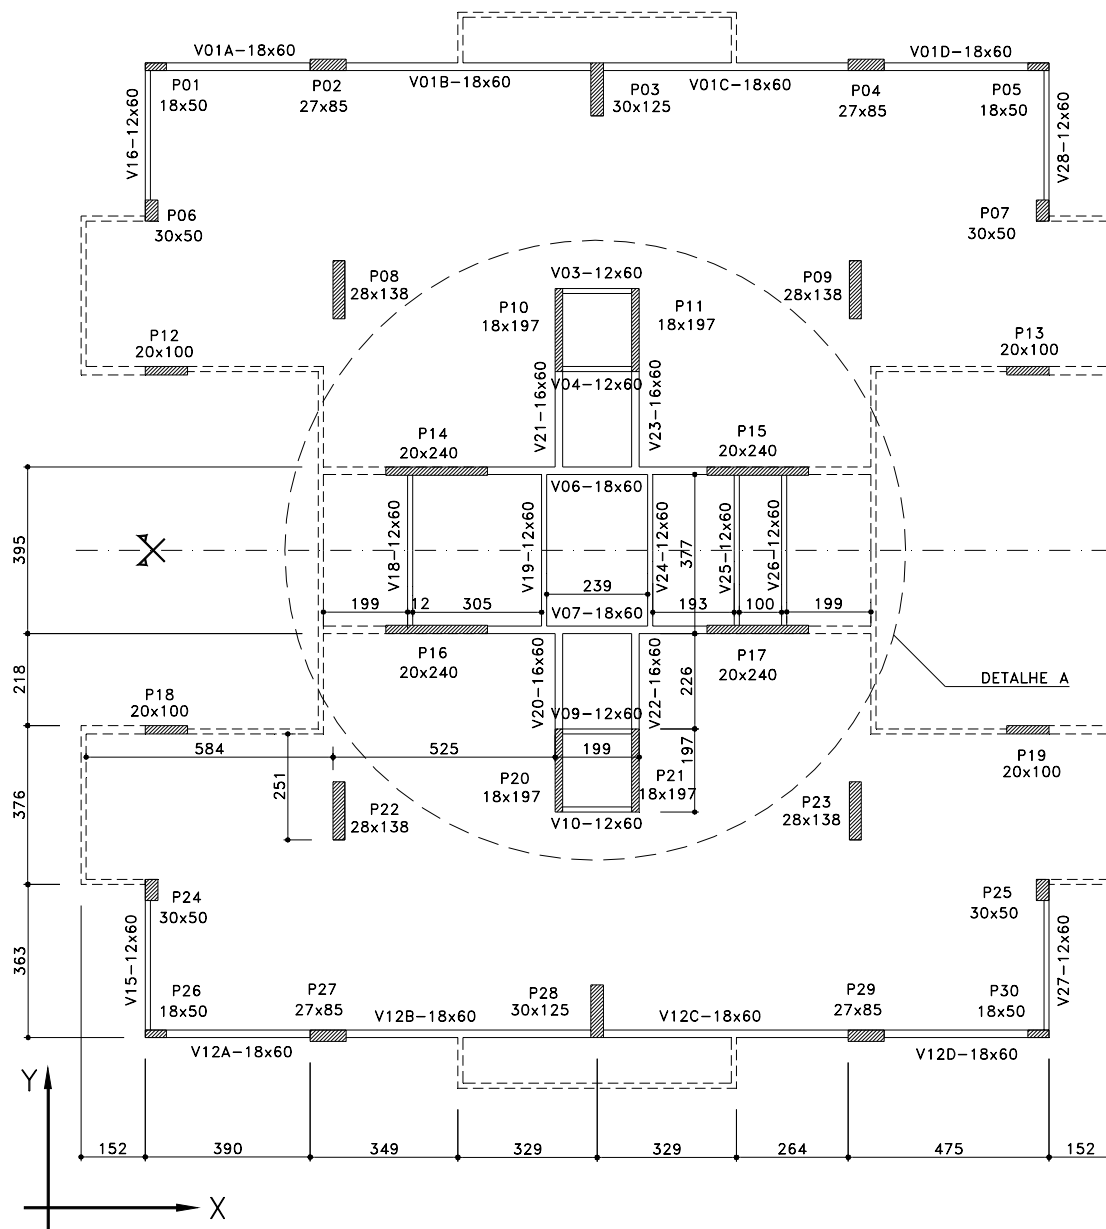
Forma do pavimento tipo do edifício Maison Royale (cm)
